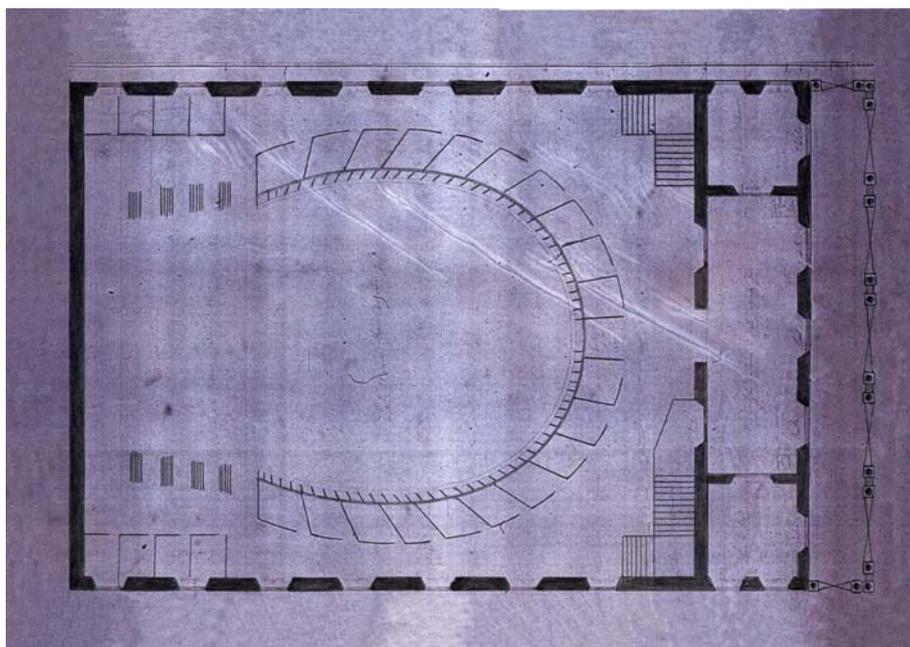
Proyecto del Teatro Reina Isabel II. Plano de planta. Projectado por Ingeniero Manuel Heredia en 1848. Fuente: Instituto de Historia y Cultura Militar de Madrid (I.H.C.M.). Cartoteca. N° plano 12.320.
